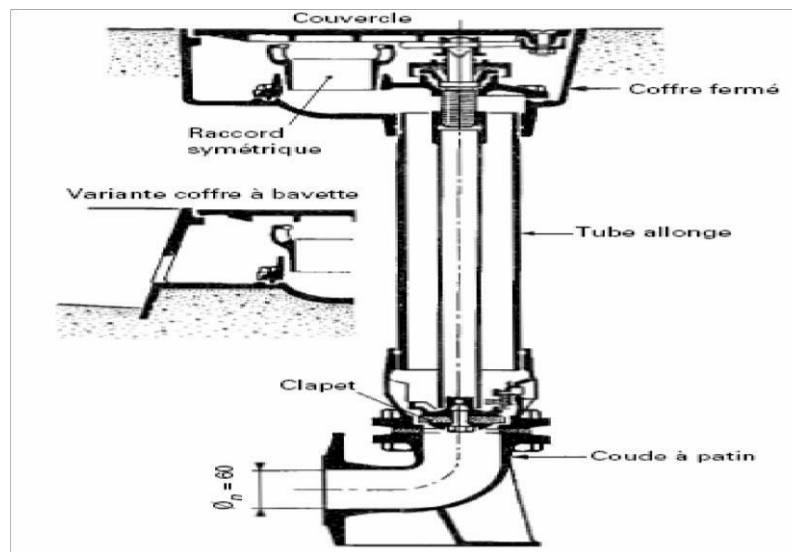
Bouche d'incendie ou de lavage (D'après document Pont-à-Mousson).
